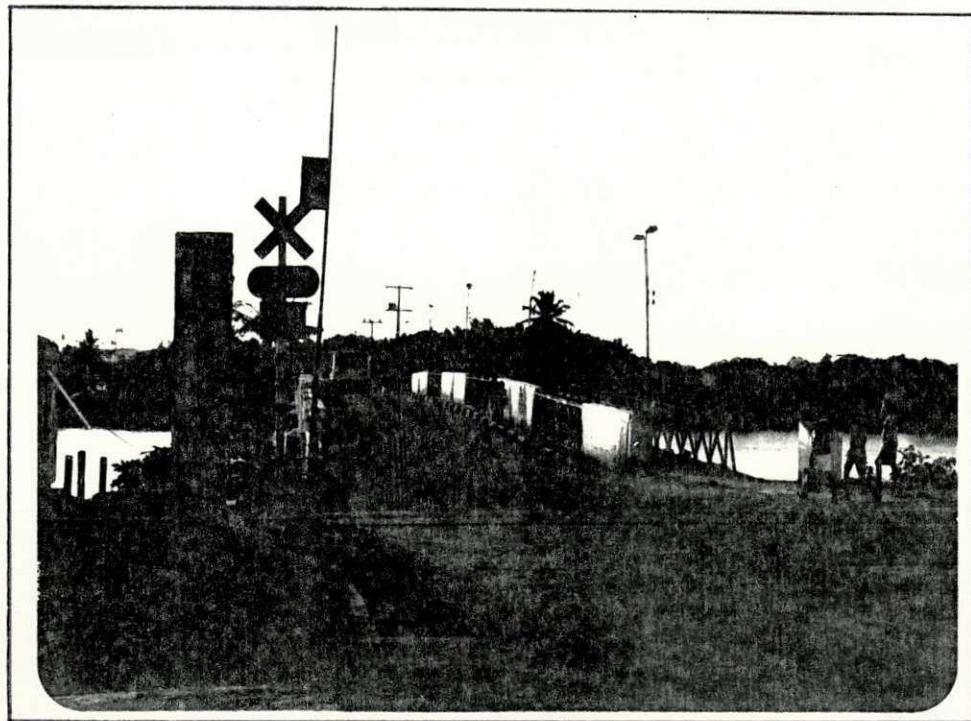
Vista da ponte existente sobre o Rio Sanhauá, com passagem para um só veículo e com limitação de carga para 12t.
